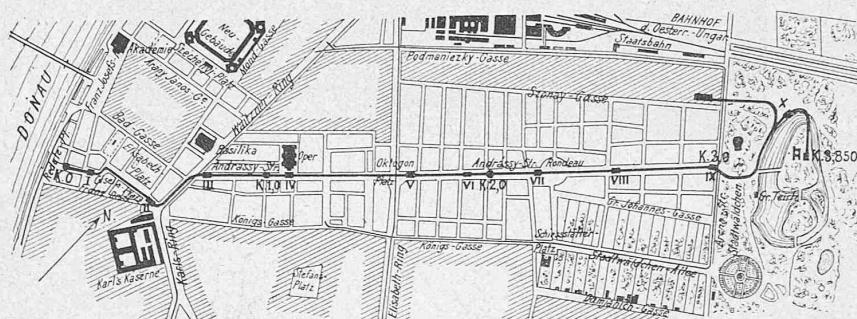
Lageplan mit Tracé. — Maßstab 1:30000.
